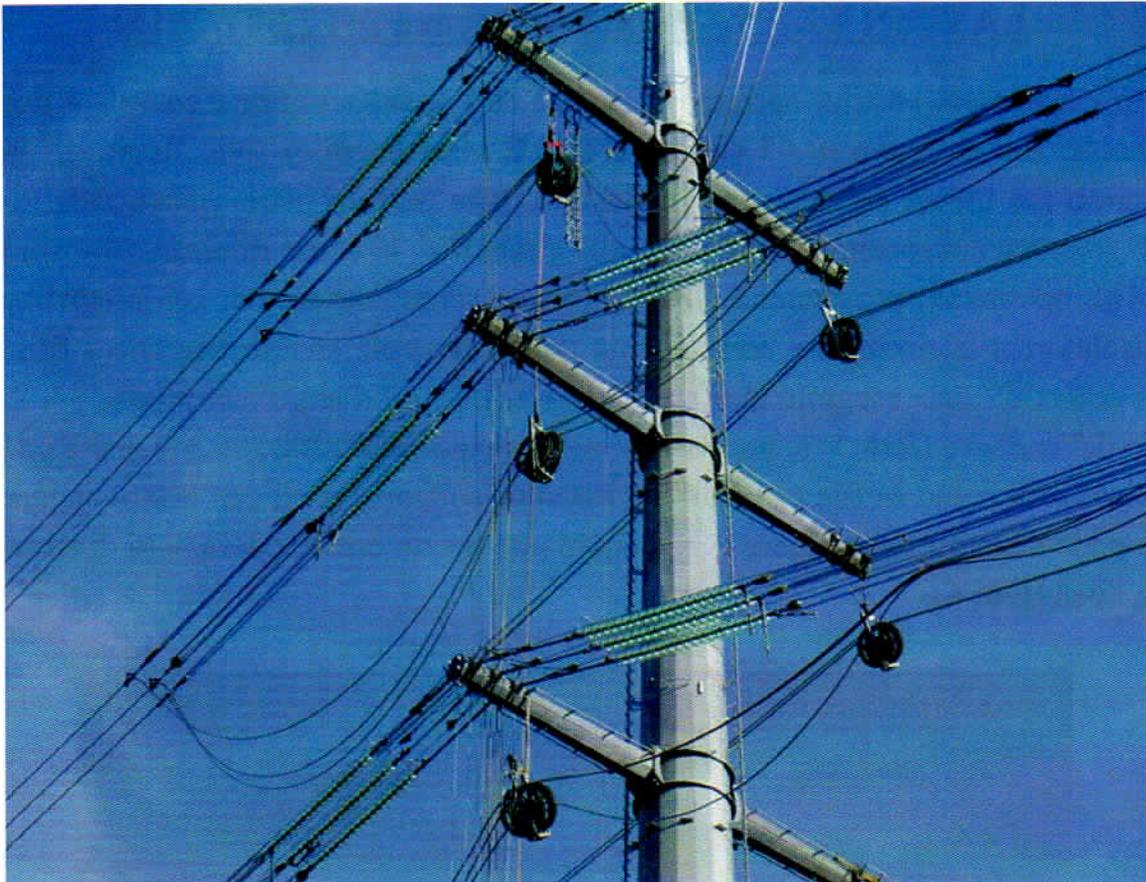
sostegno n. 43 vista laterale dalla strada Sammardenchia-Lavariano il 04/08/15
